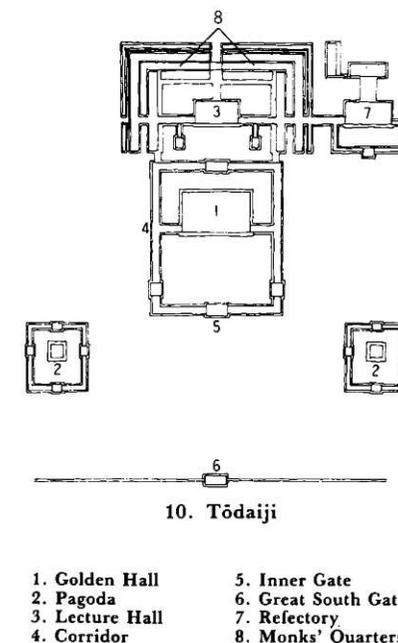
Tōdaiji, Grundriss des Tempels
